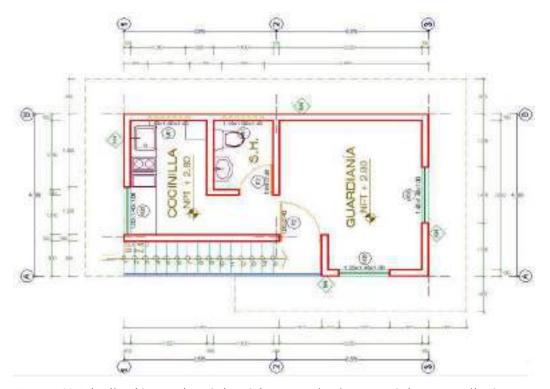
Distribución arquitectónica típica segunda planta en tópico y guardianía-bloque 05
